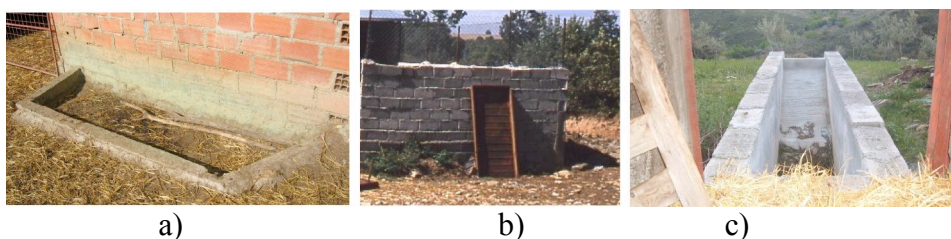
Pedilúvios: construído à entrada (a) e metálico (b); e tanque-banheiro (c).
